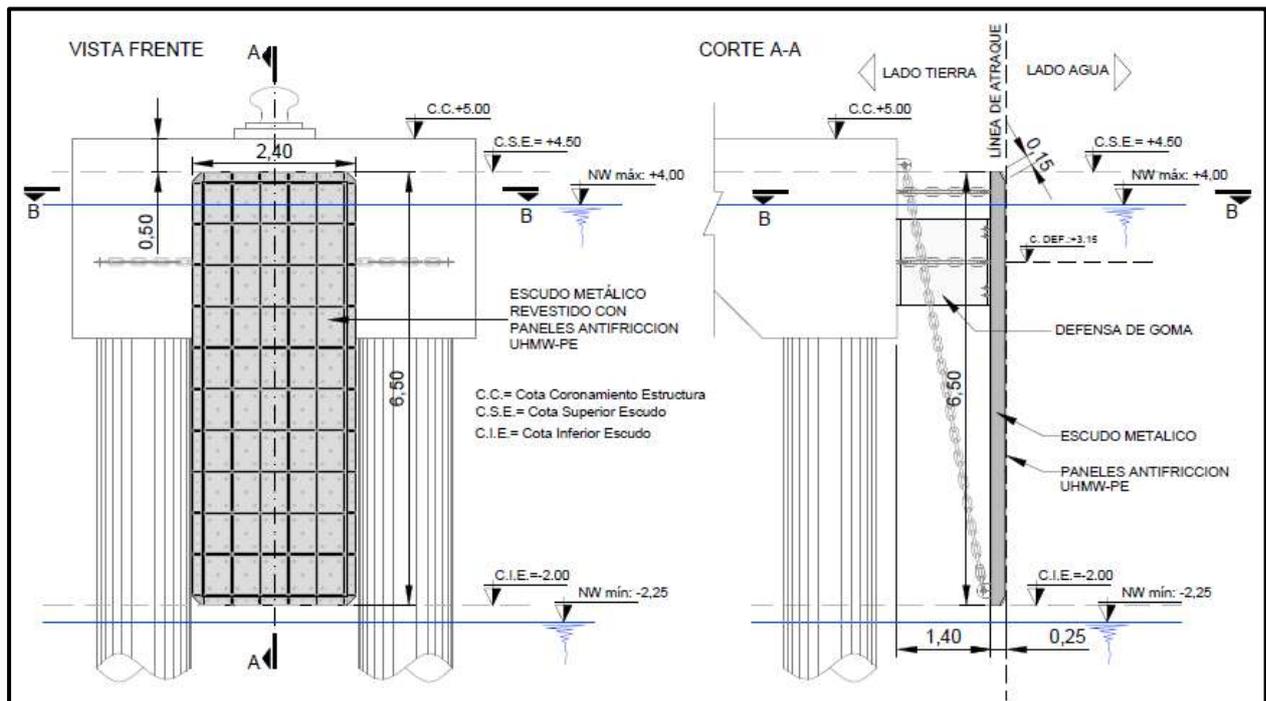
Vista y corte longitudinal del escudo a construirse
